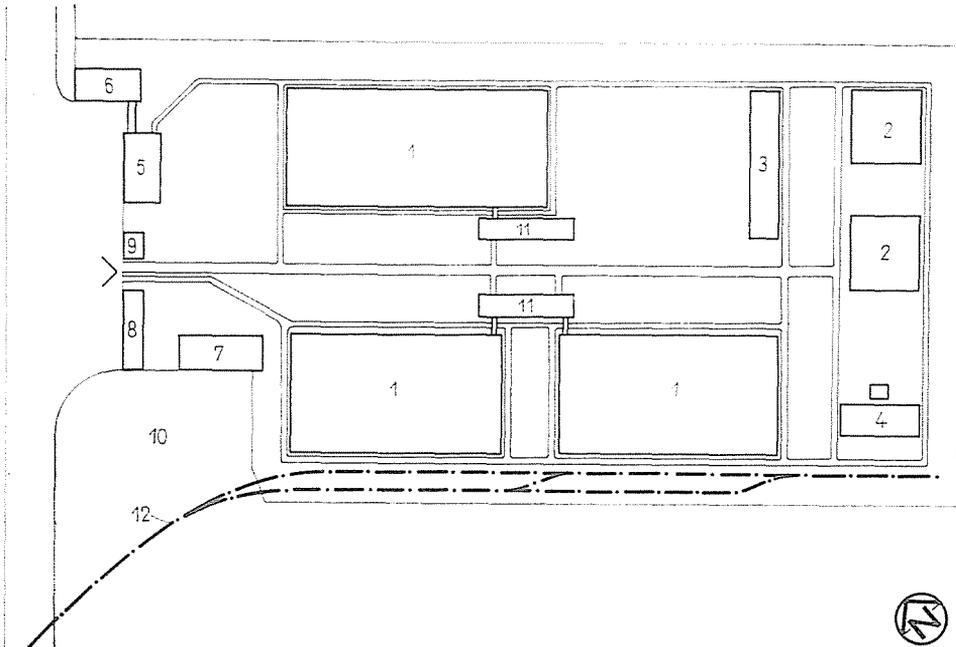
Bebauung in der Kompaktbauweise (Ungarn): 1 — eingeschöfiger Produktionsbau; 2 — Geschoßbau; 3 — planmäßige Instandhaltung und Garage; 4 — Kesselraum und Transformatorraum; 5 — Küche — Speisesaal; 6 — Büro; 7 — Laden und Lehrlingschule; 8 — Fahrradaufbewahrung und Feuerwehr; 9 — Portierloge; 10 — Parkfläche; 11 — Sozialgebäude; 12 — Eisenbahngleis
